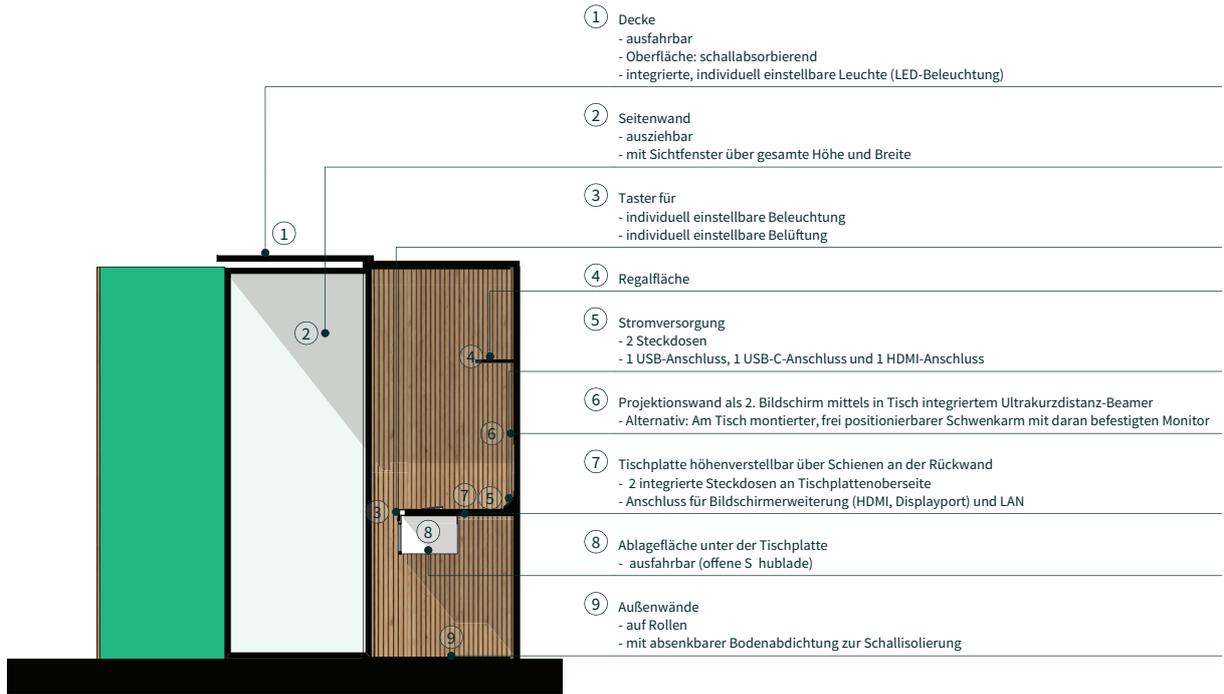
Grundriss des *Flap-and-Fold-Office
